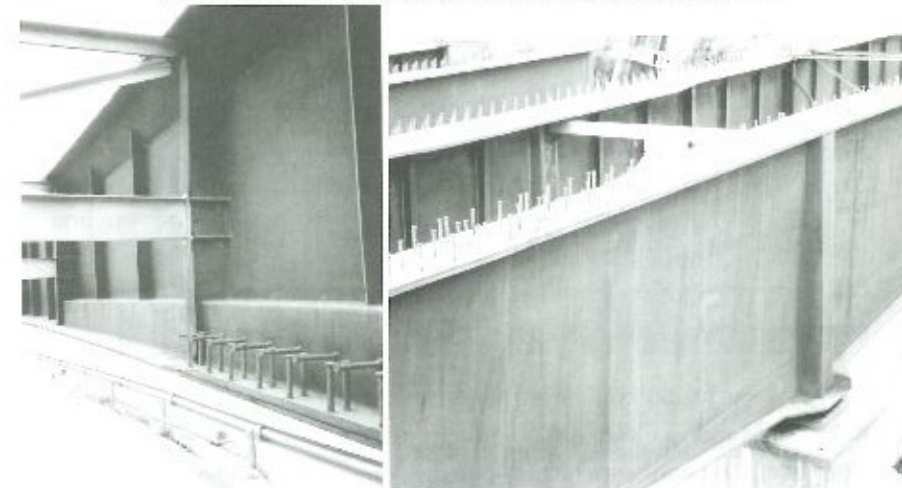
Detalle de la conexión de la losa inferior sobre pilas y del rigidizador sobre apoyo
